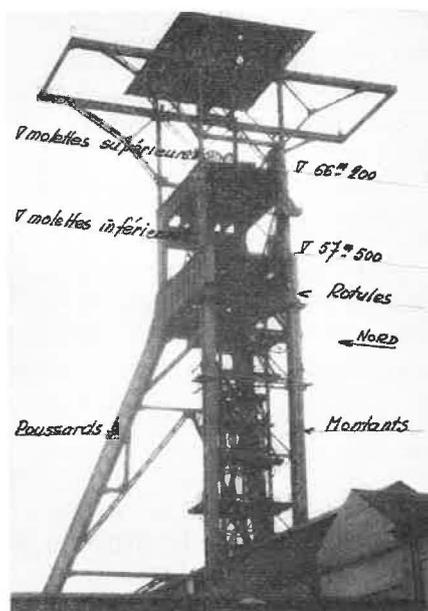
Vue d'ensemble du châssis à molettes du puits de rentrée d'air.
